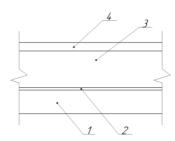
Устройство перекрытия по холодному чердаку: 1 — армированная стяжка; 2 — каменная минеральная вата; 3 — пароизоляция Технониколь; 4 — монолитная ж/б плита.
